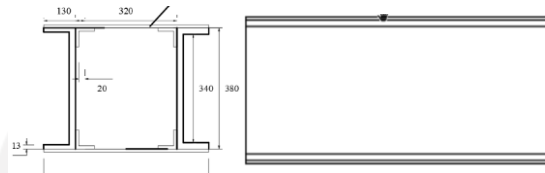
5 Tampak Melintang dan Memanjang Barang Diagonal Tipe 2
